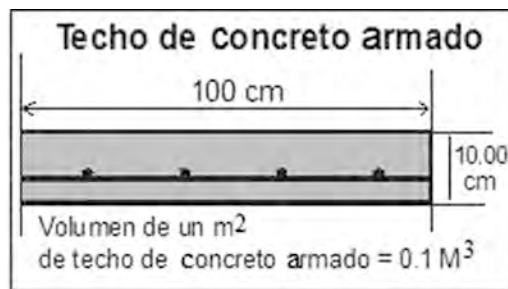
Corte esquemático de techo de concreto armado, con el cálculo del volumen de concreto en un metro cuadrado de techo.
